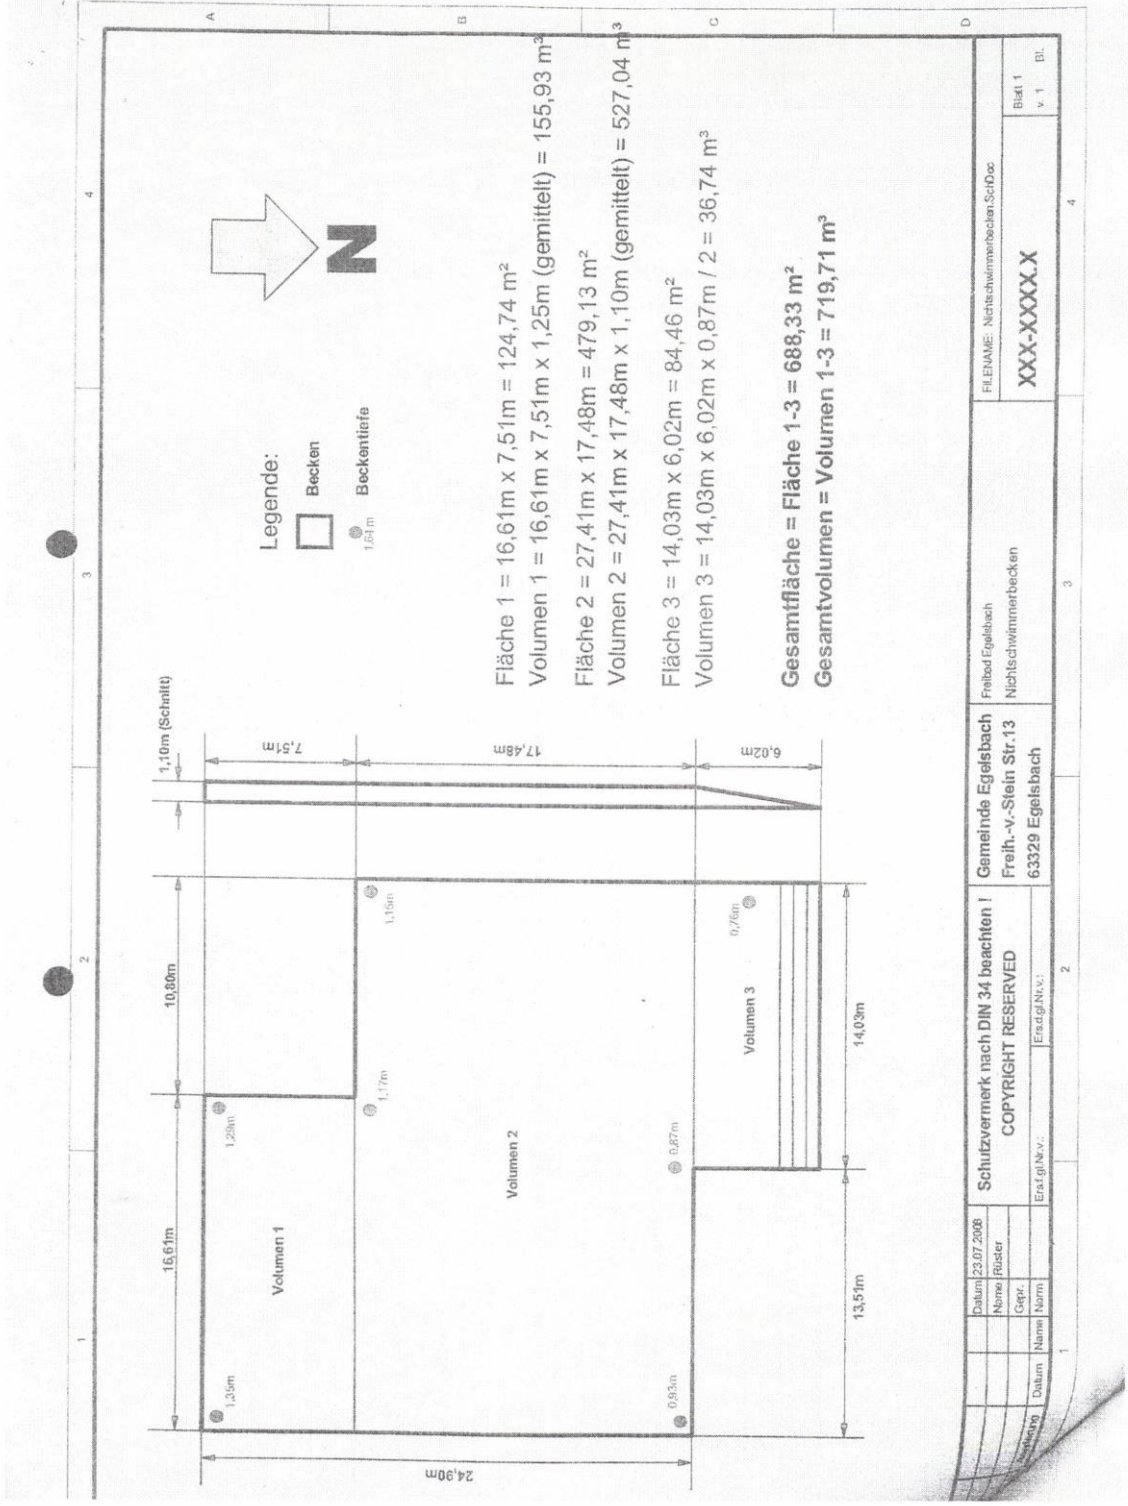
Plan Nichtschwimmerbecken (NSB)
